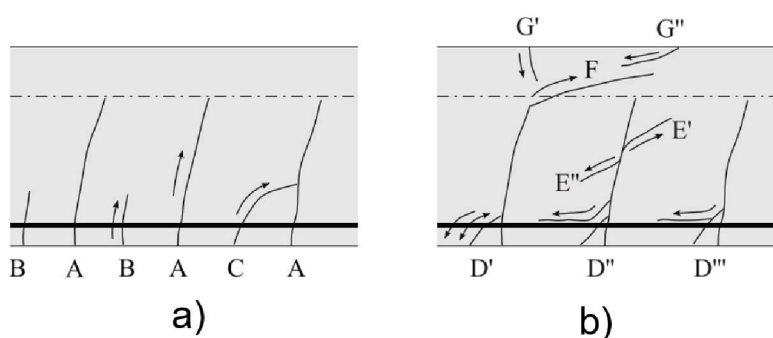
Tipos de fissuras: (a) fissuras de flexão primária e secundária; e (b) fissuras causadas por ações de transferência de cisalhamento.
